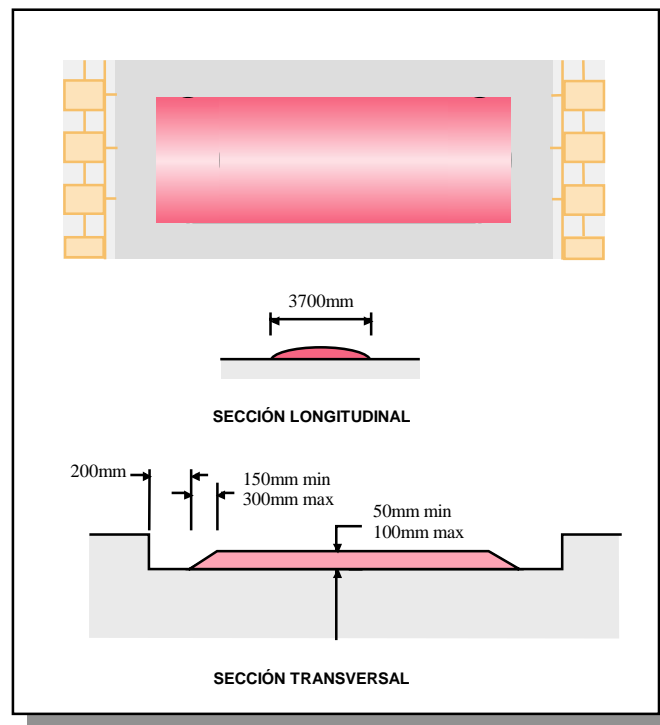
Policía acostado de perfil circular: planta, sección transversal y longitudinal.
